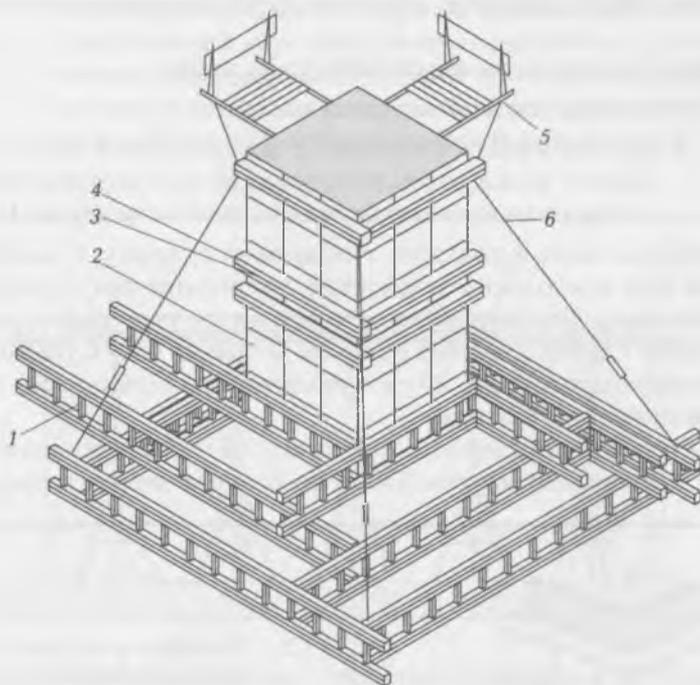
Стальная опалубка ступенчатого фундамента:
